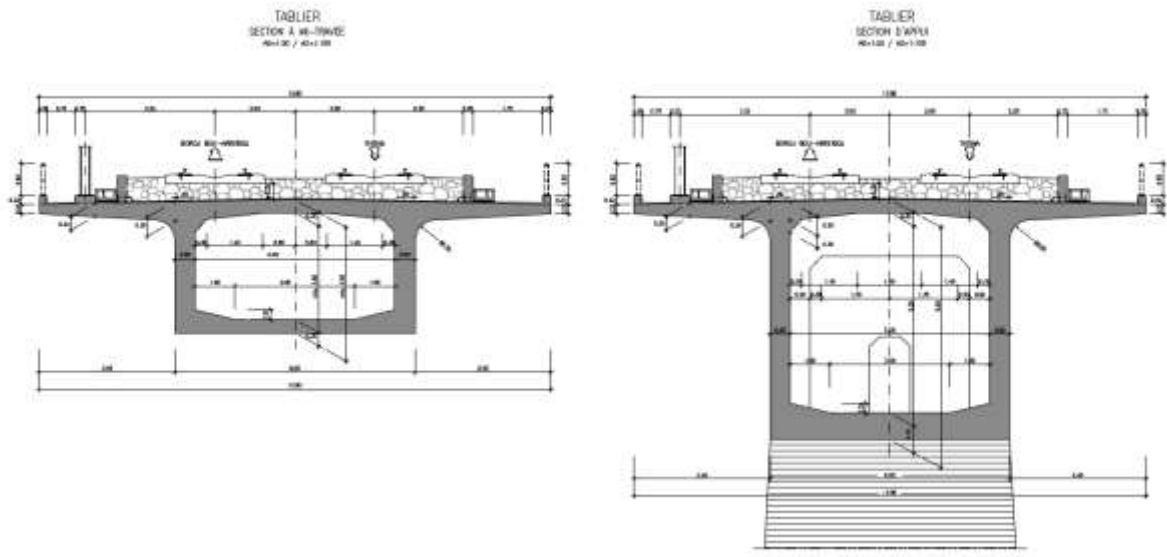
Coupe type du tablier – Pont central (sections sur appui et à mi-travée)
